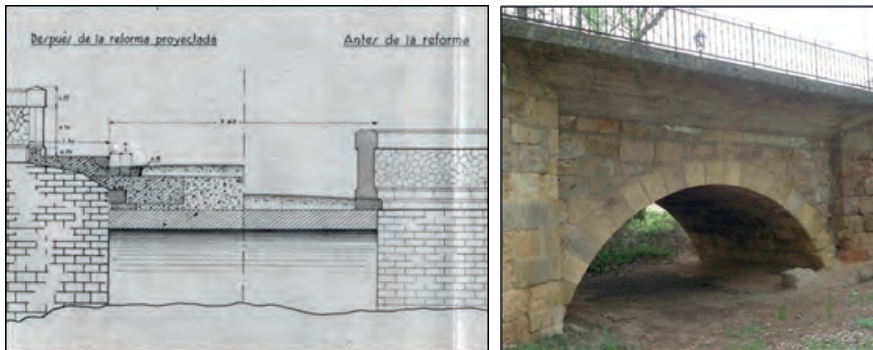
Sección transversal antes de la reforma y después de la reforma. Andenes laterales construidos. (Fuente: Proyecto original de la Reparación del Puente en 1929).
